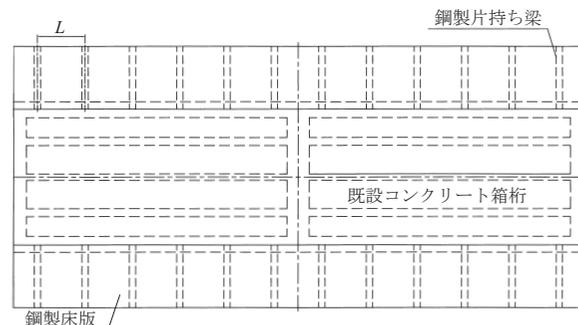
SCWCBM により拡幅した箱桁橋の平面図
